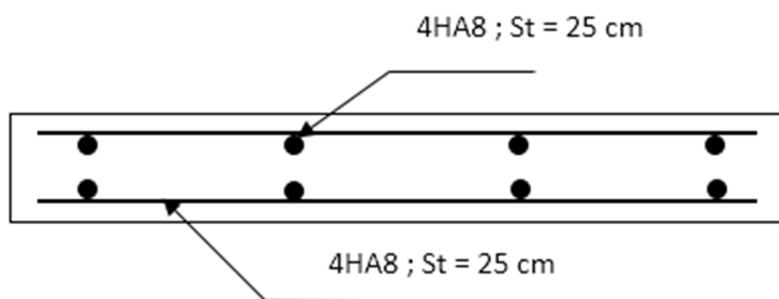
Schéma de ferrailage de la Dalle sur deux appuis
